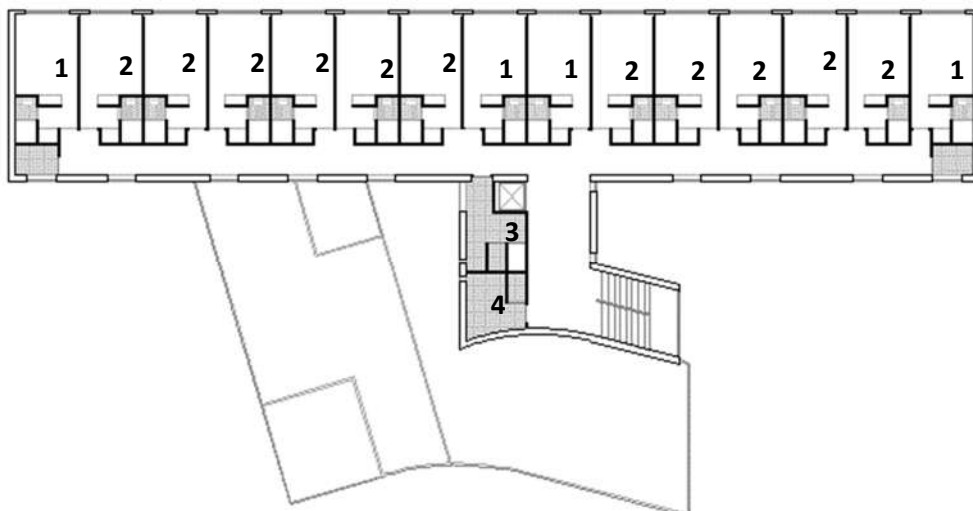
Planta Nível 1, 2, 3. 1: Copa. 2: Dormitórios. 3: Banheiro. 4: Área de serviço. Pavilhão Suíço, em Paris, França. Fonte: Archdaily.
